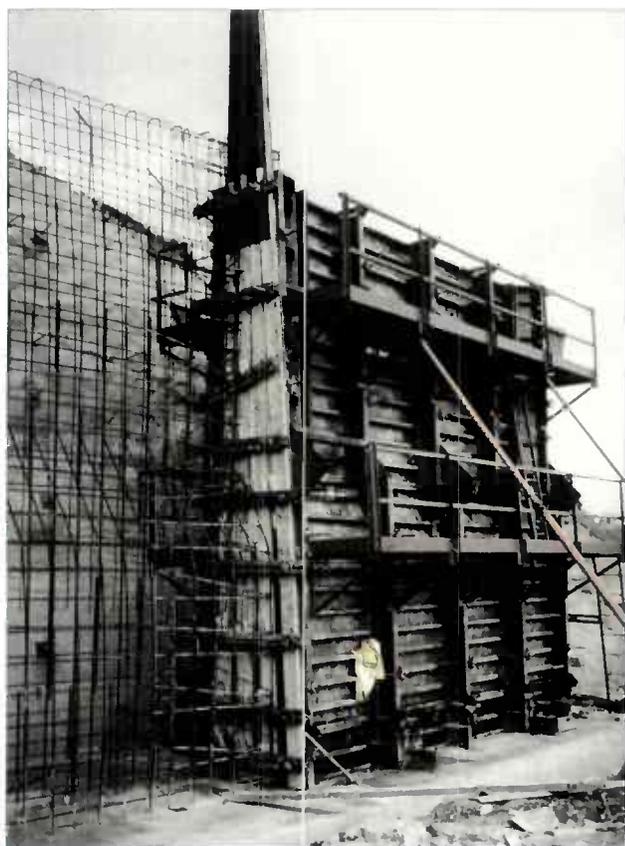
Réalisation d'un mur en béton armé coulé en place
